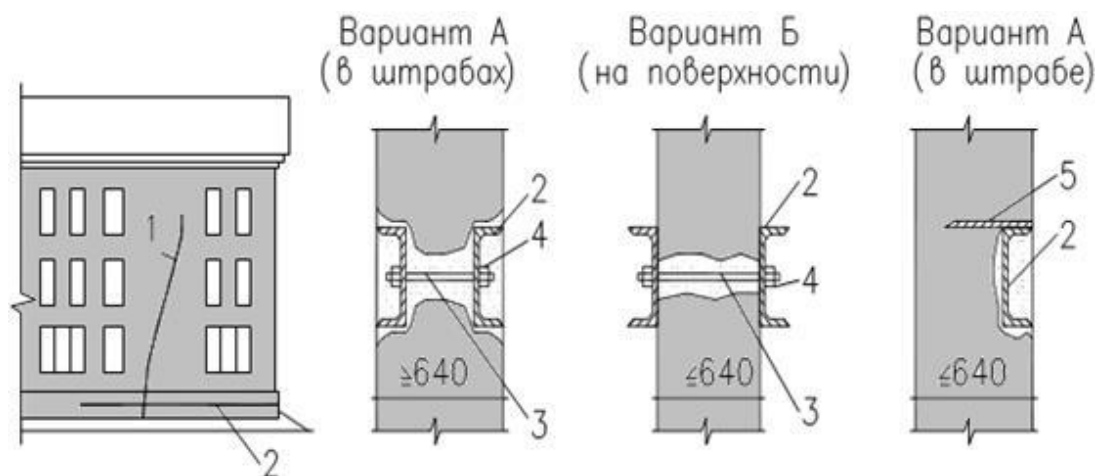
Усиление части здания устройством предварительно напряженного стального пояса из прокатных профилей: 1 – трещина, 2 – пояс из швеллера, 3 – стяжной болт, 4 – гайка, 5 – анкер
